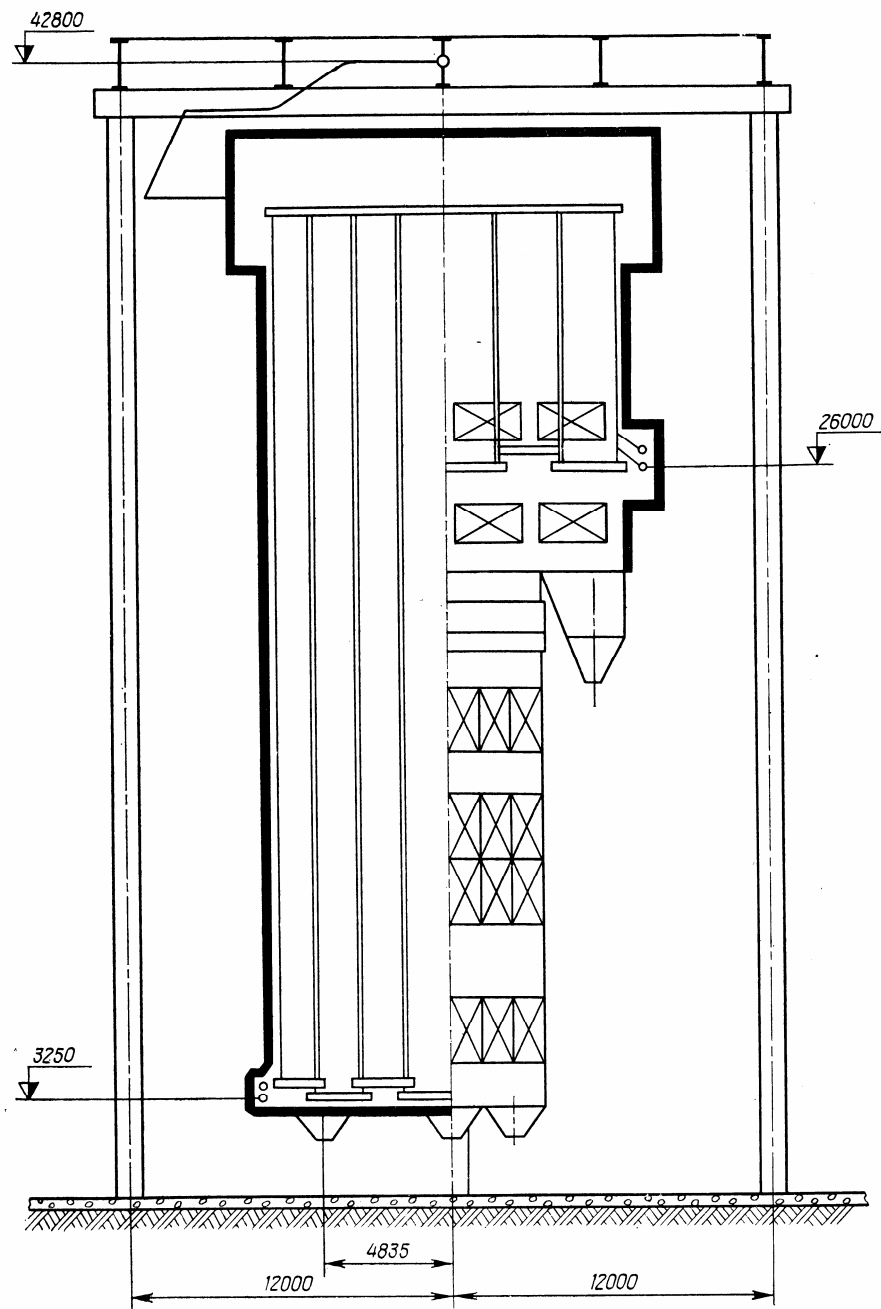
Поперечный разрез котла Е-420-13,8-560 КДТ (ТРЕ-429)
